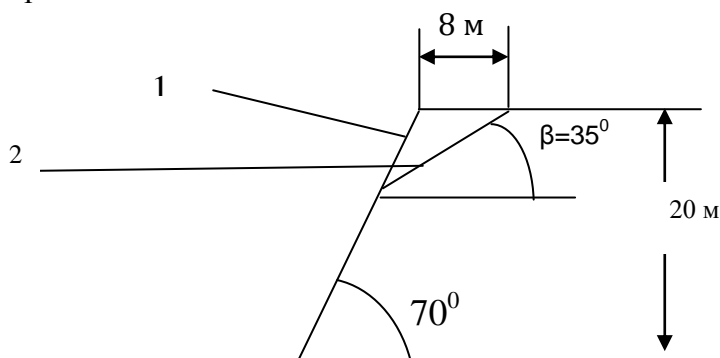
Схема поперечного сечения уступа: 1- откос; 2 - поверхность ослабления
